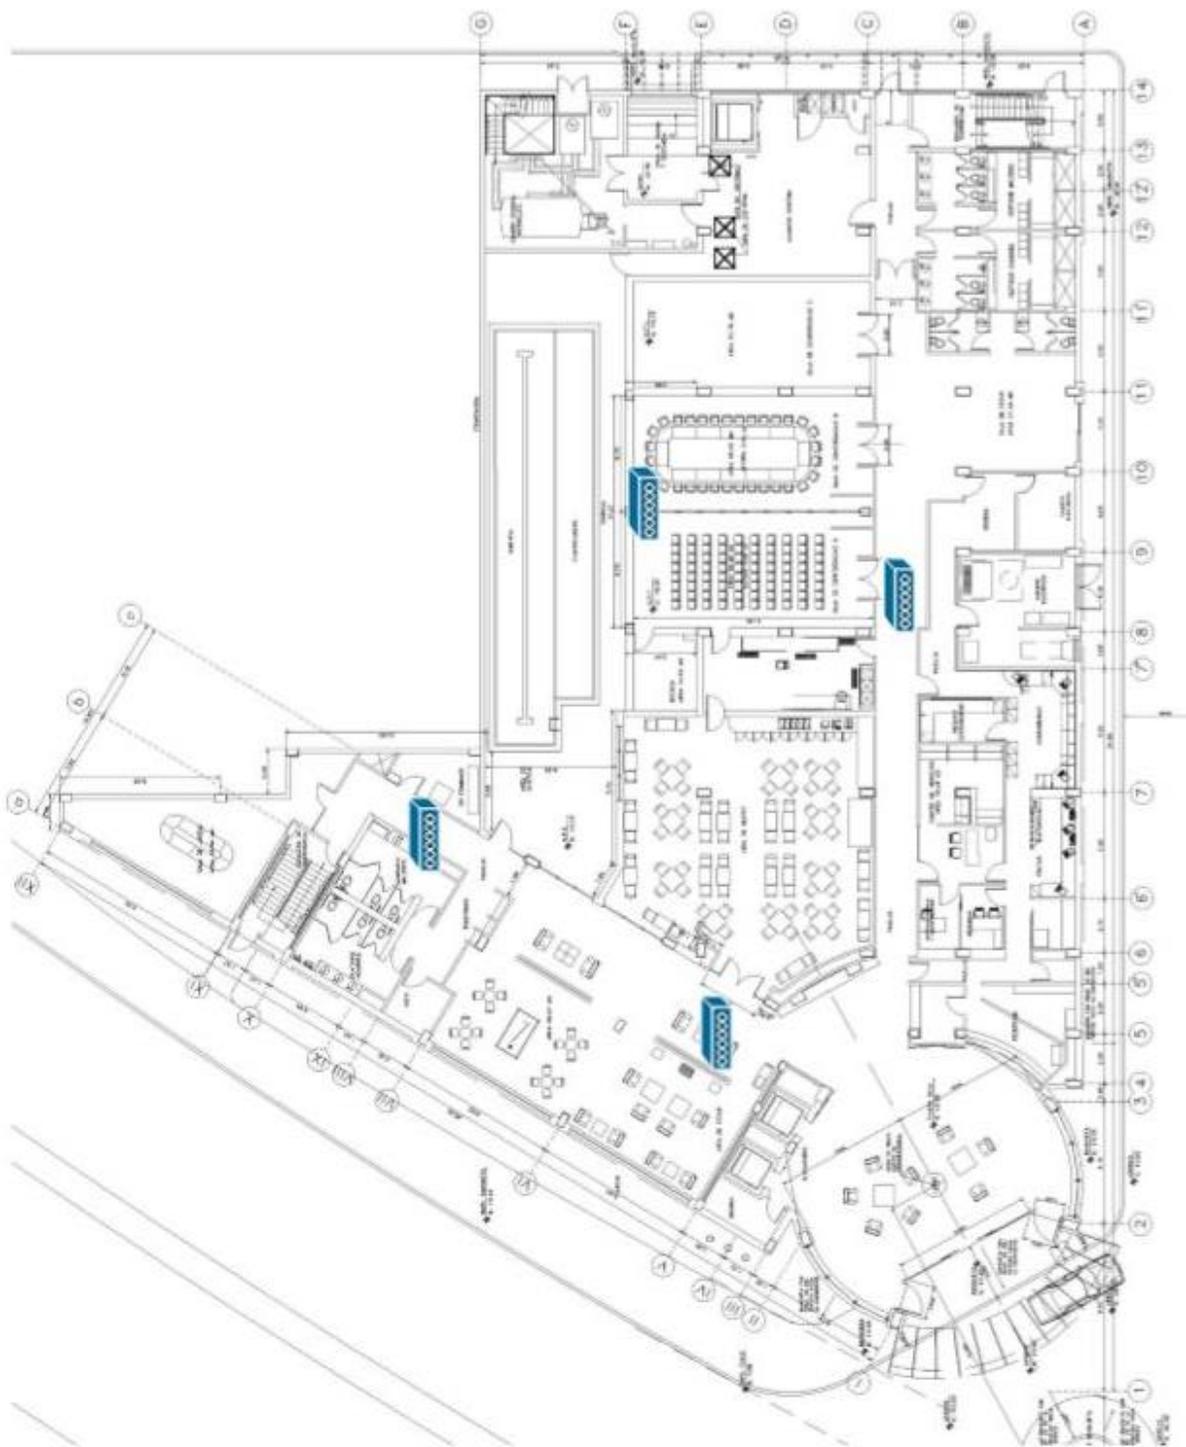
Plano de ubicación de puntos de acceso en planta baja.
